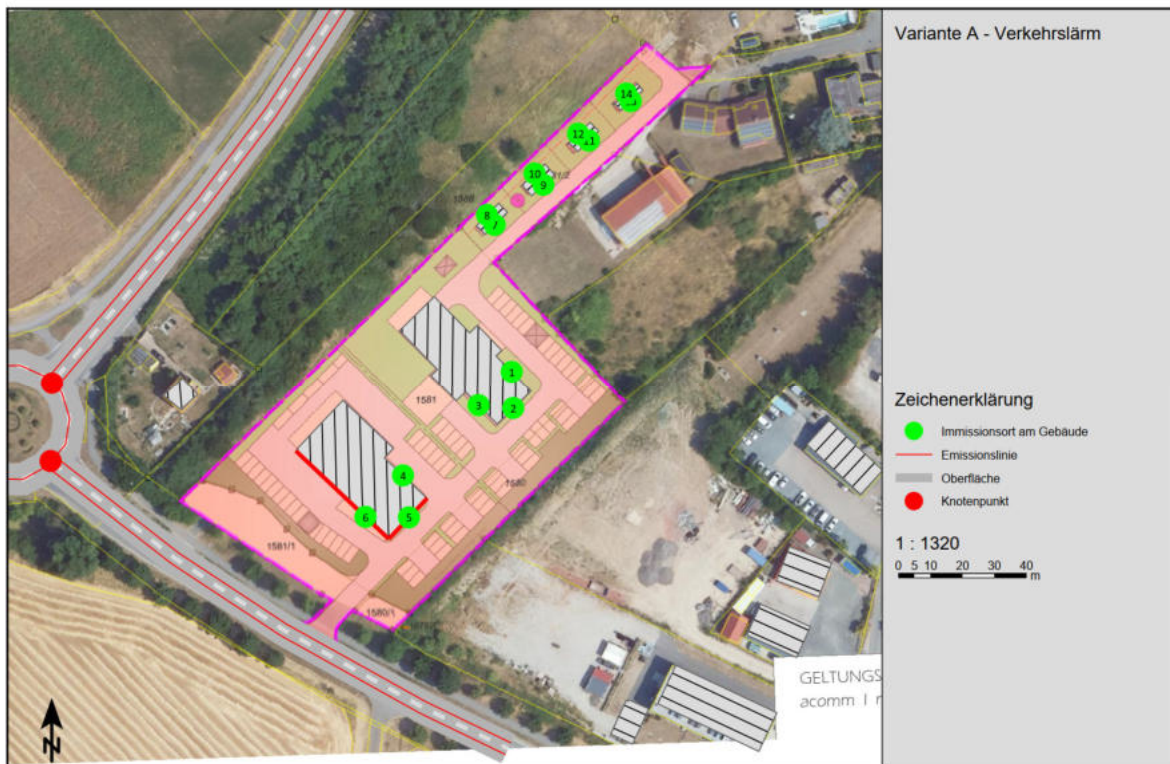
Lageplan mit Emissions- sowie Immissionsorten (IO, grüne Beurteilungspunkte) – Variante A
